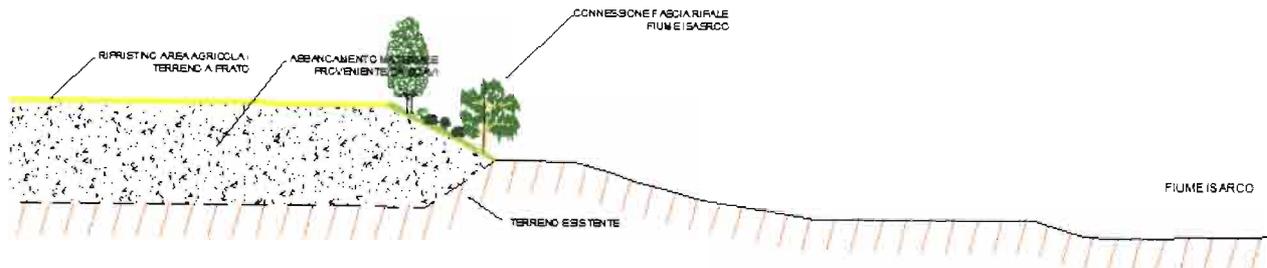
Sezione A-A' della Planimetria delle opere a verde in corrispondenza del deposito Vorderrigger.
